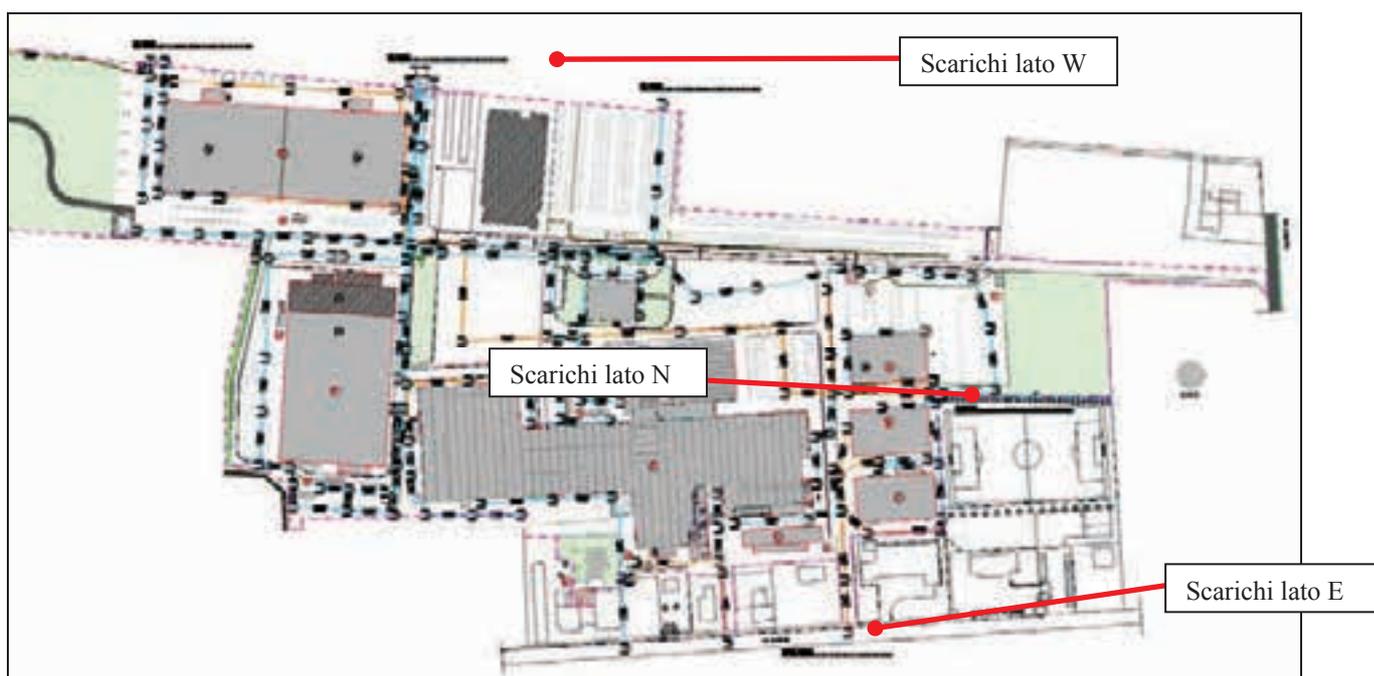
Lay-out della rete di drenaggio principale a servizio dell'area di comparto esistente (cfr. TAV 06 A di studio).
